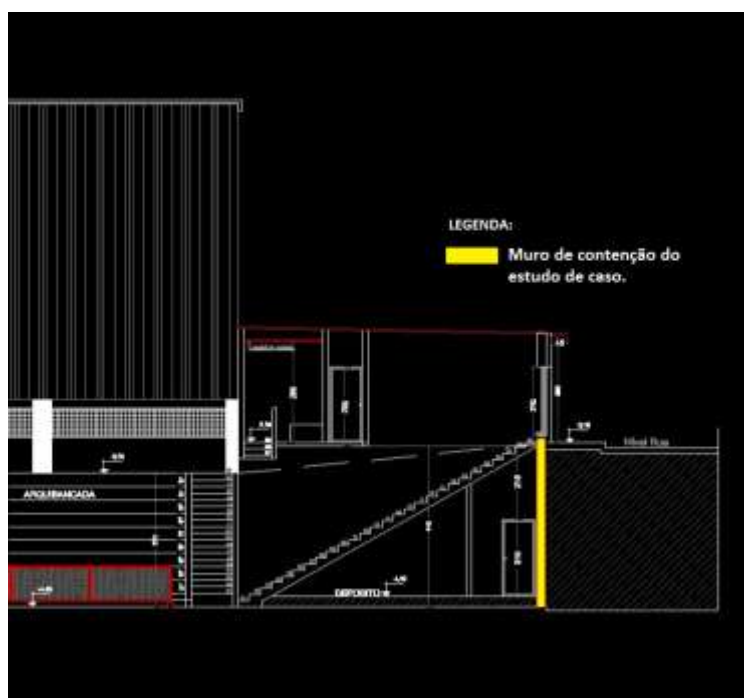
Vista da fachada do Ginásio de Esportes JK.
